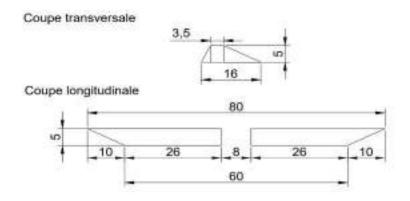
Coupe longitudinale et transversale du Seuil-filtrant
